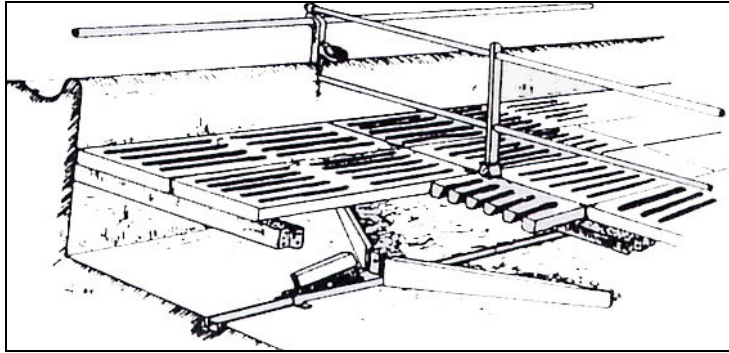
Raschiatore meccanico installato al di sotto del pavimento fessurato
